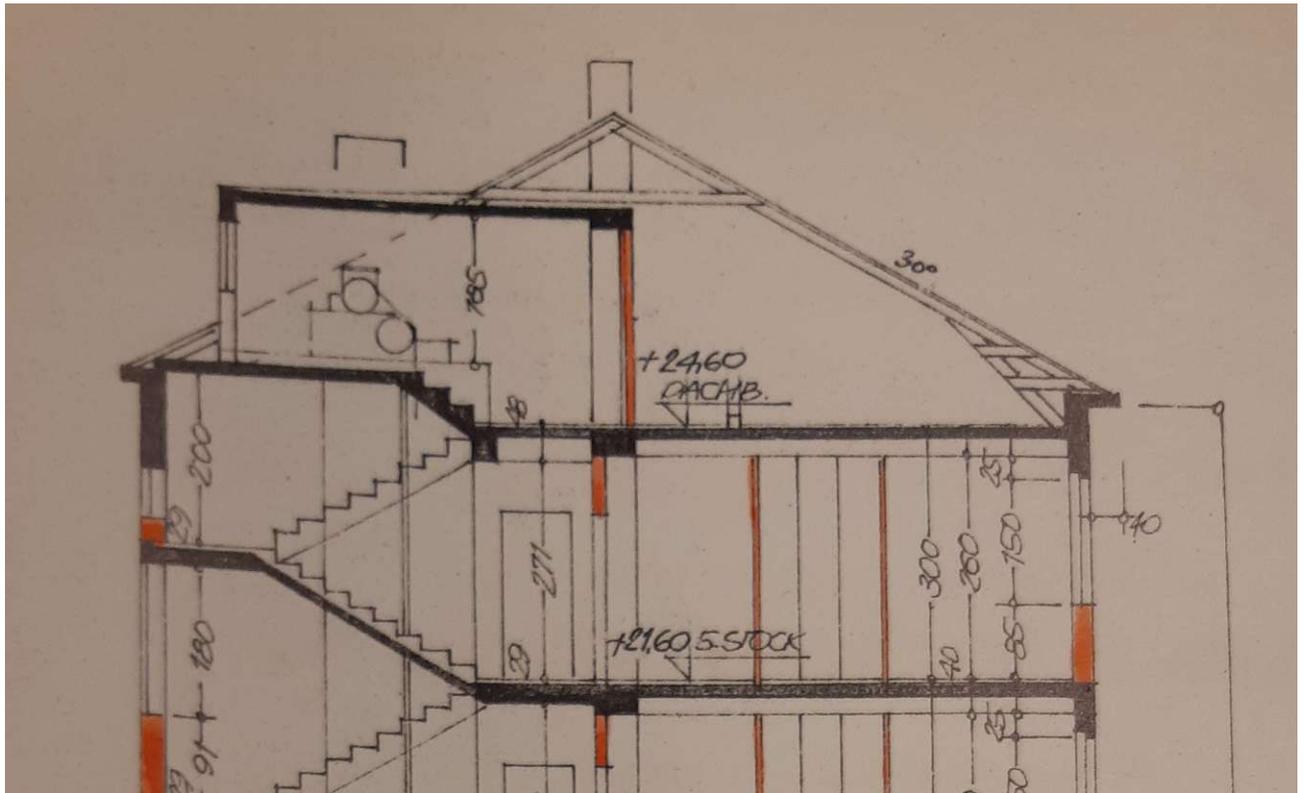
Negerlegasse 4 - Schnitt Stiege 1, Bestandsplan 1964
